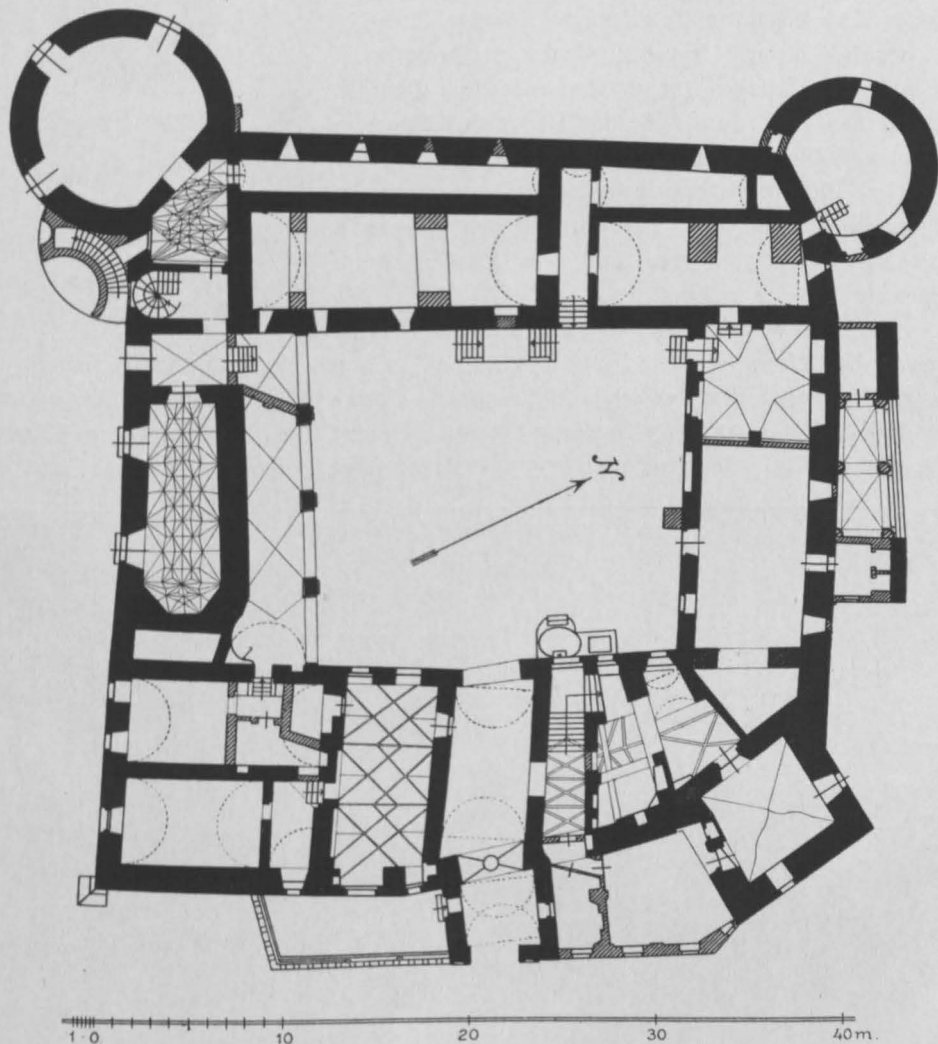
Fürstlich Drehna. Schloß, Grundriß.
